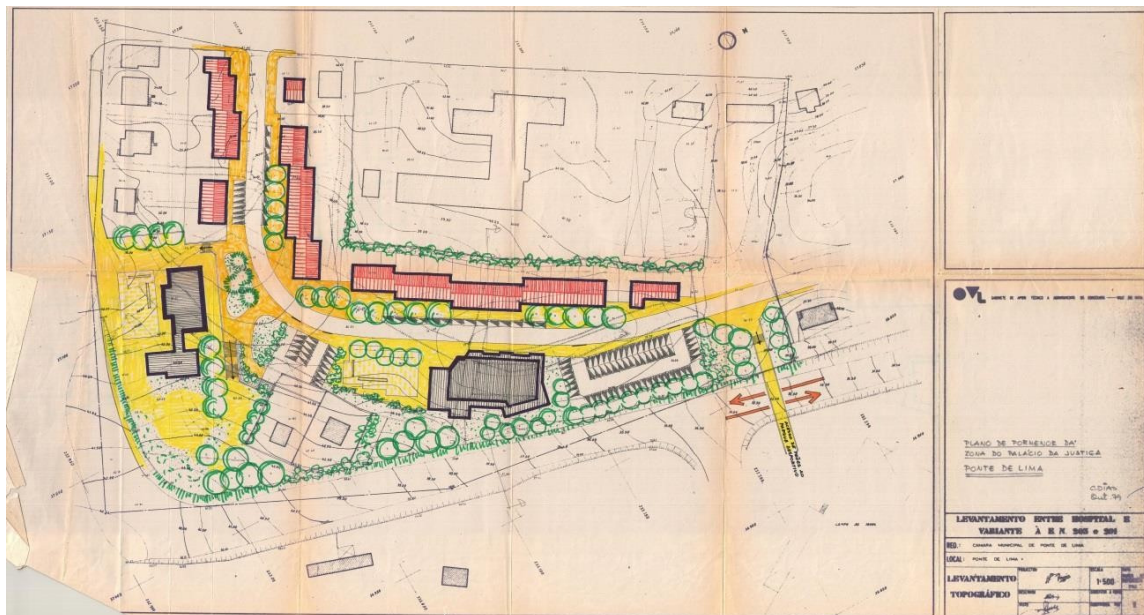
Planta de Pormenor da Zona do Palácio de Justiça - 1979
